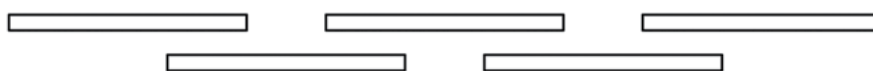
Układ montowany do konstrukcji oszalunku pod wylewkę stropu
